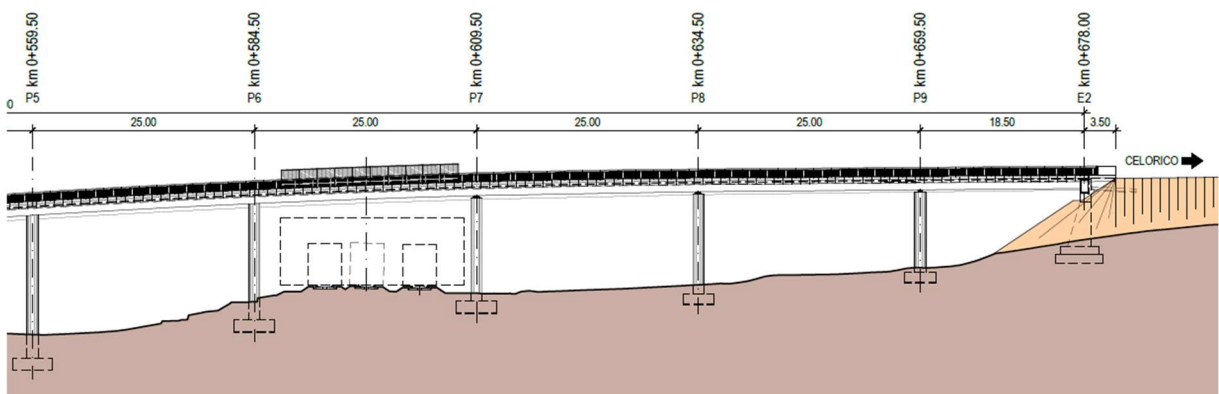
Corte longitudinal 2 do viaduto de Celorico Gare
